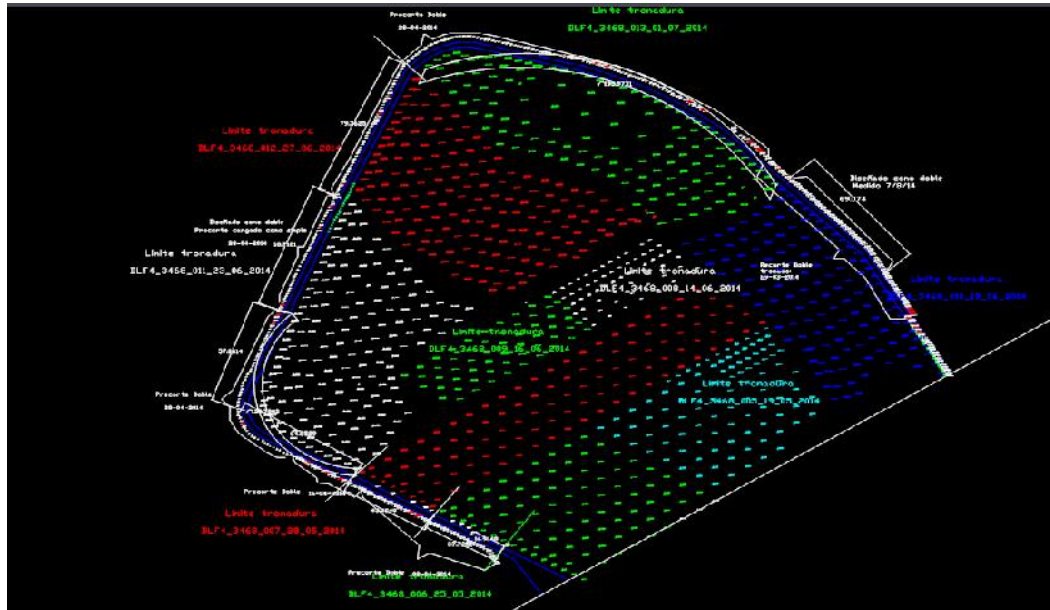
Vista en planta mallas de perforación banco 3468.
